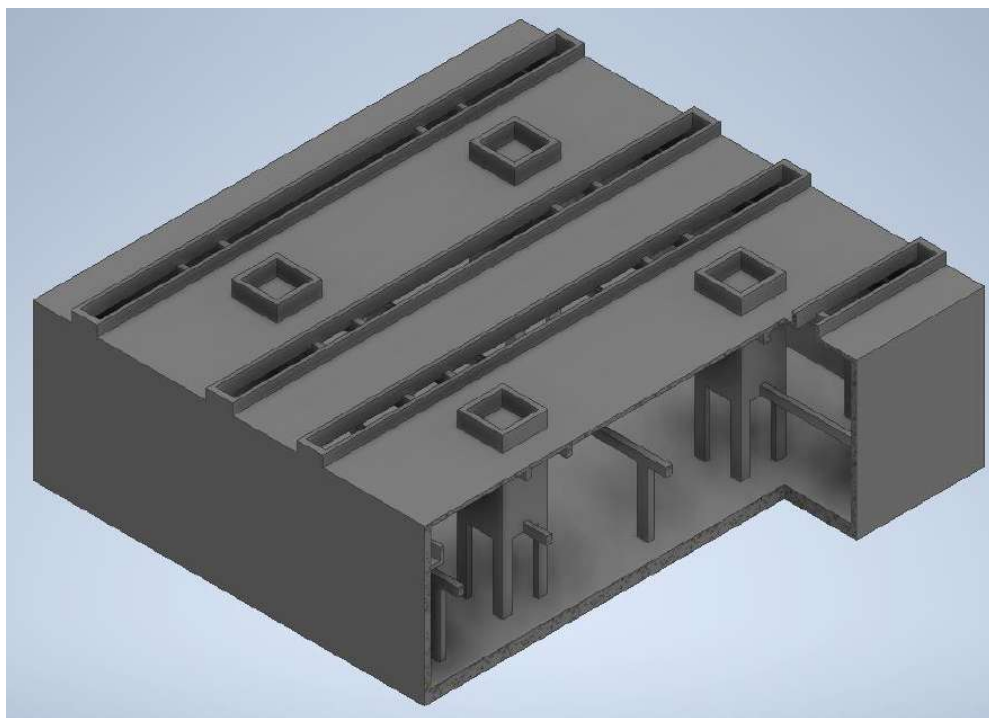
Vista em corte do tanque do reator UASB da ETE Canyon. Destaque para as aberturas na laje de cobertura para acesso ao interior do reator (1); e vigas de suporte da laje de cobertura (2).
